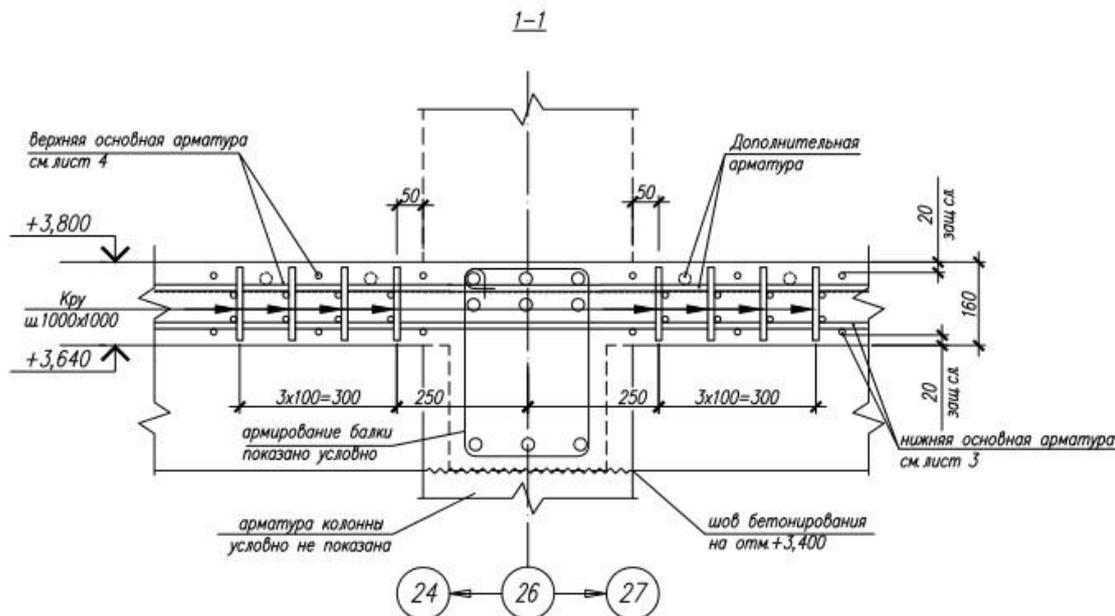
Армирование опорных зон второстепенной балки сварными сетками (арматура балок условно не показана)
